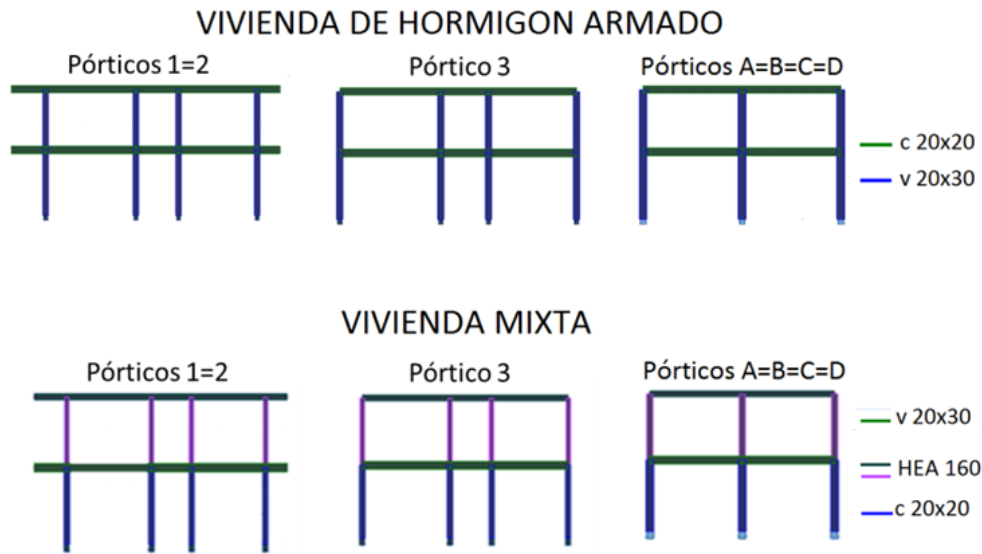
Vista de pórticos. Viviendas V12RC y V12M.
